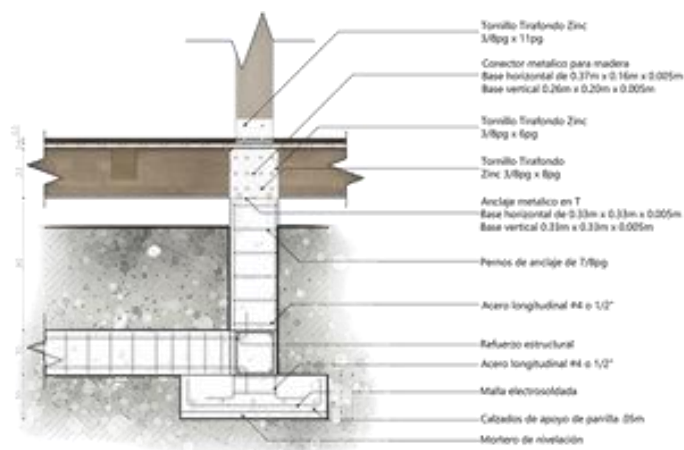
Detalle constructivo de zapata. Elaboración propia.
